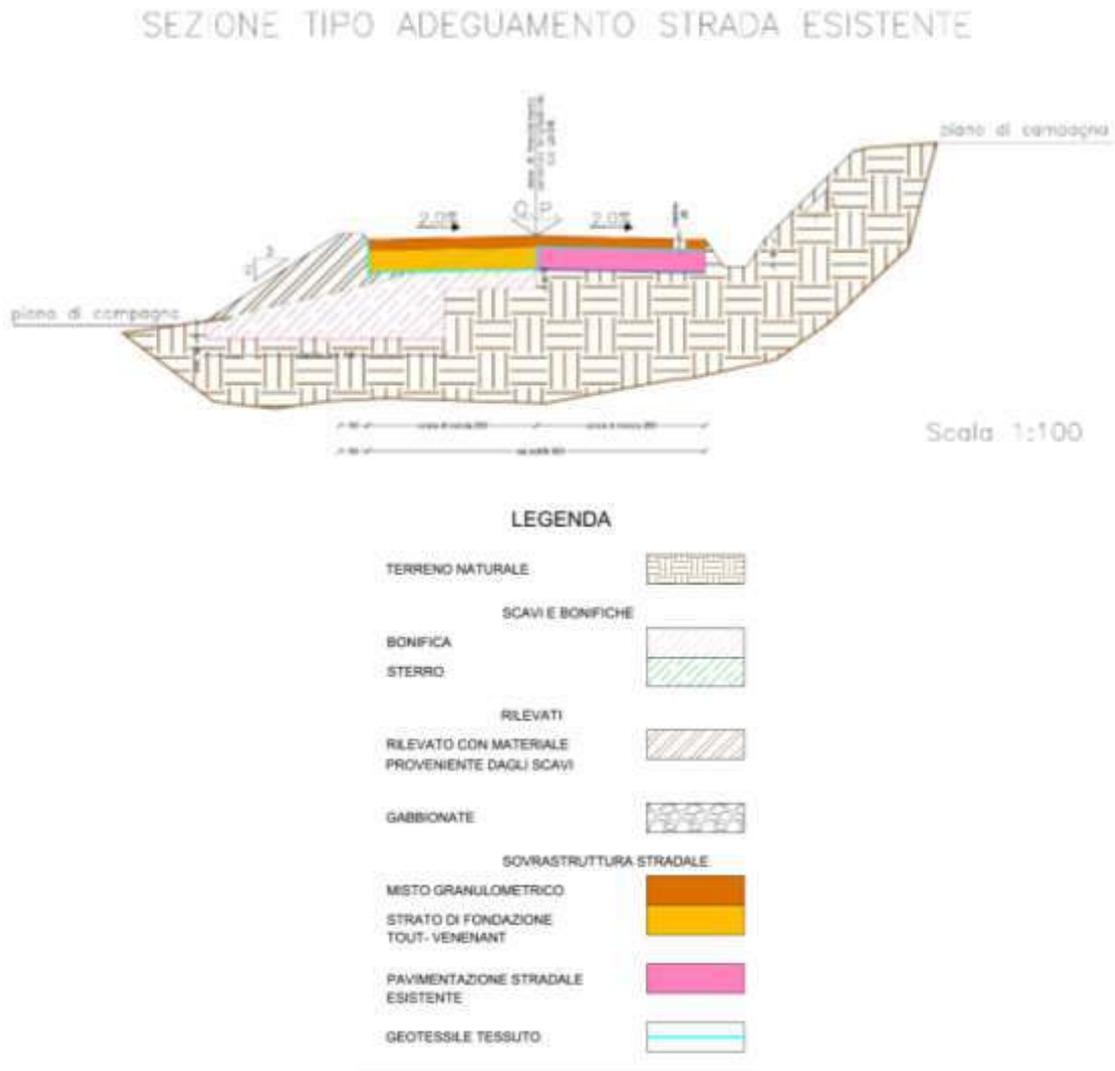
Sezione tipo adeguamento strada esistente
